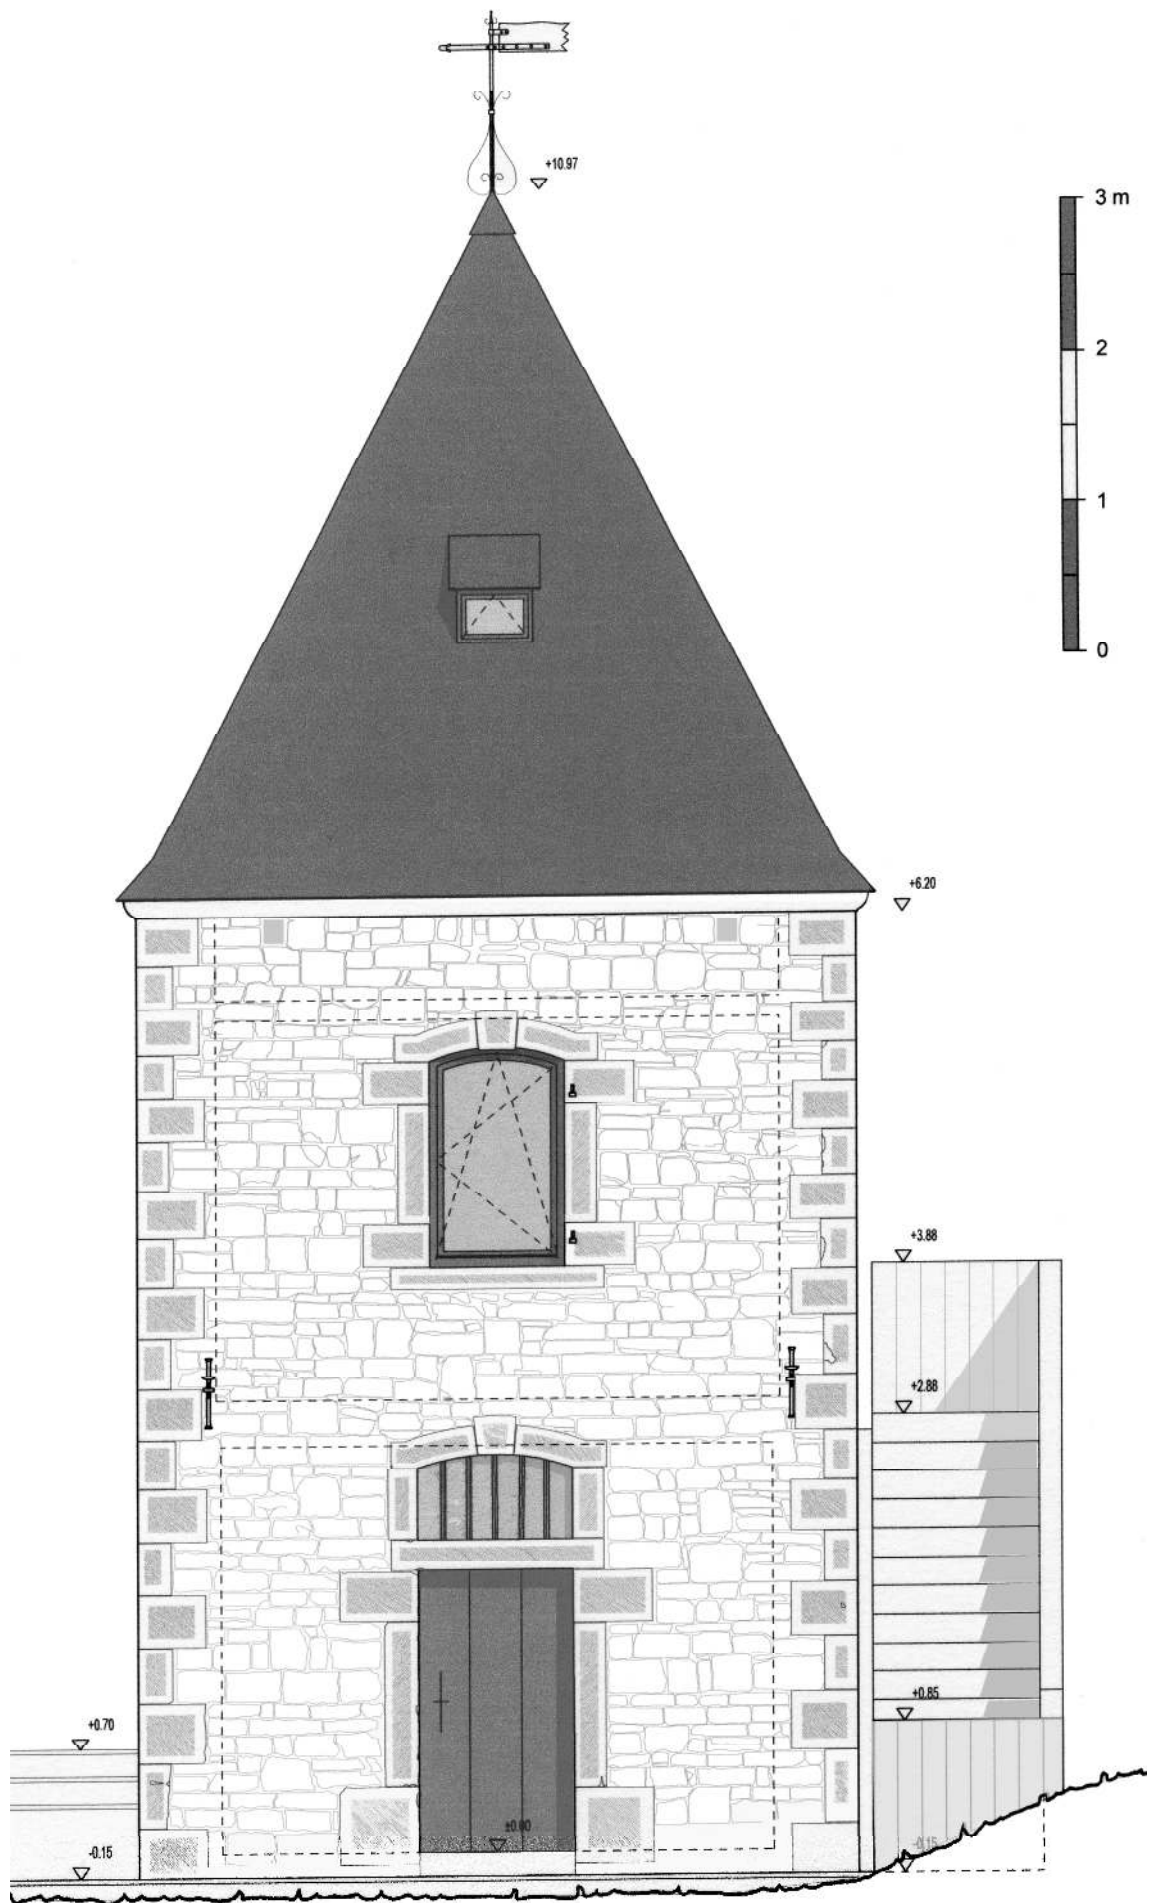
Pavillon. Elévation NO. Ech. 1/50°. Situation projetée. IG 2008.
